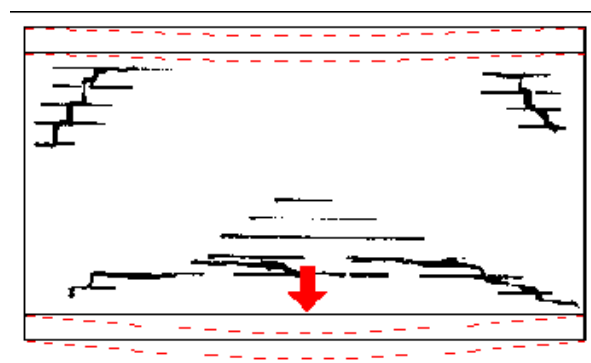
Deformação da viga de apoio maior que a viga superior, causando o fissuramento da alvenaria (THOMAZ, 1992)
